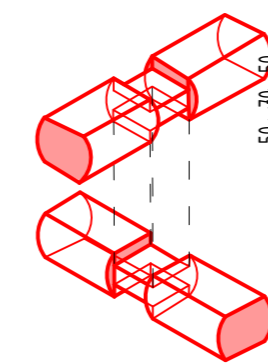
DETAIL SPOJOVÁNÍ DŘEVĚNÝCH PRVKŮ
